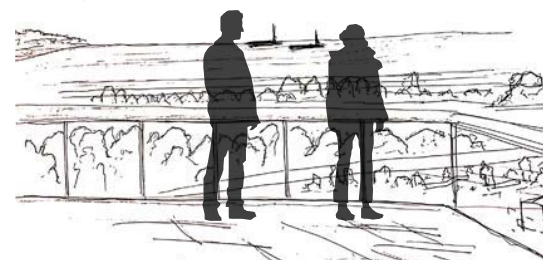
Croquis obra habitada proyecto Edificio Master plan. Fuente: elaboración propia
